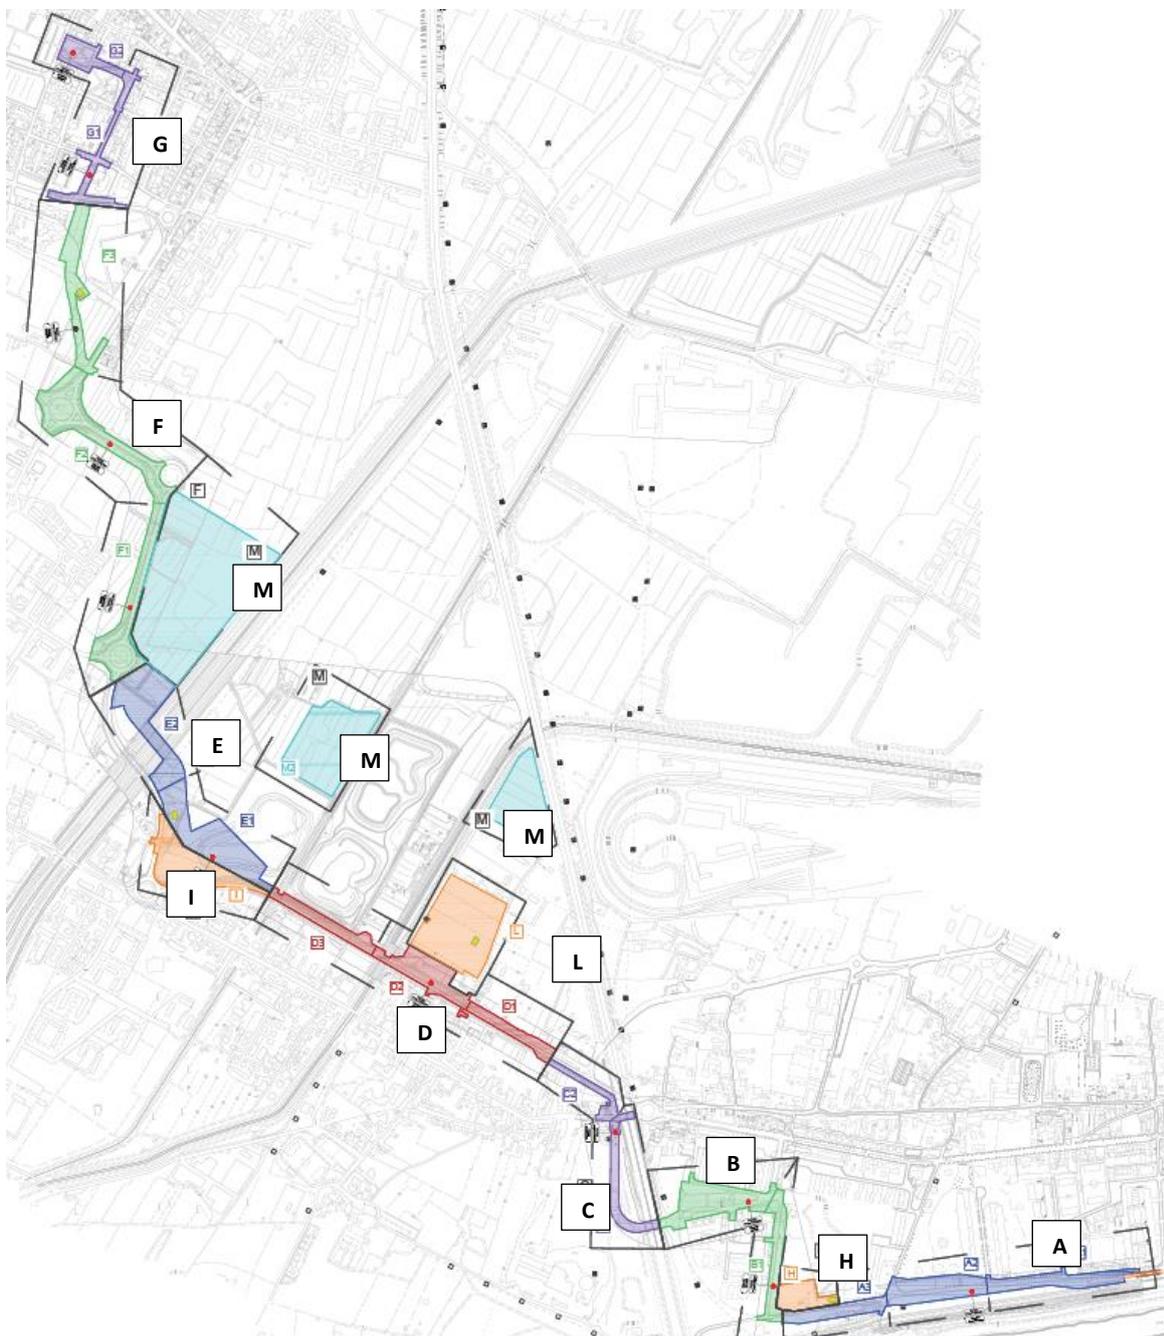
Suddivisione in sotto-aree dei cantieri
